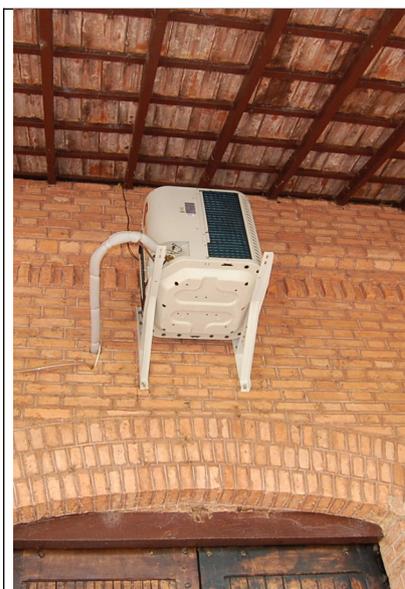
Equipamento de ar condicionado na fachada do imóvel.
